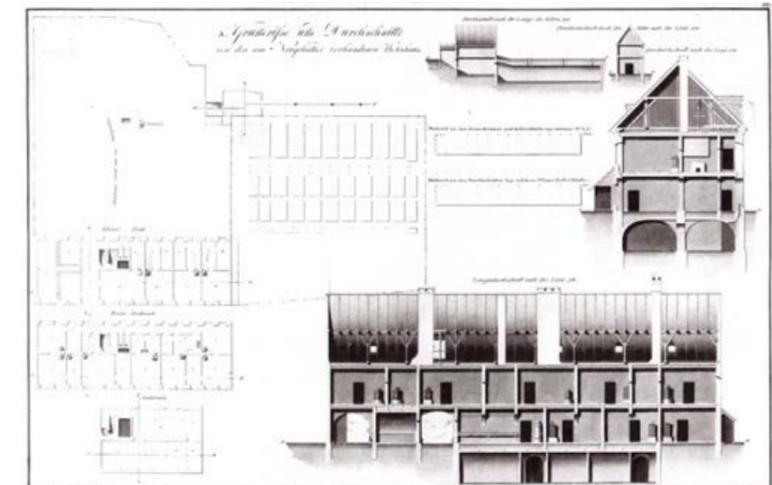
Kartensammlung Kriegsarchiv Wien, Grundriss und Durchschnitte 1826
